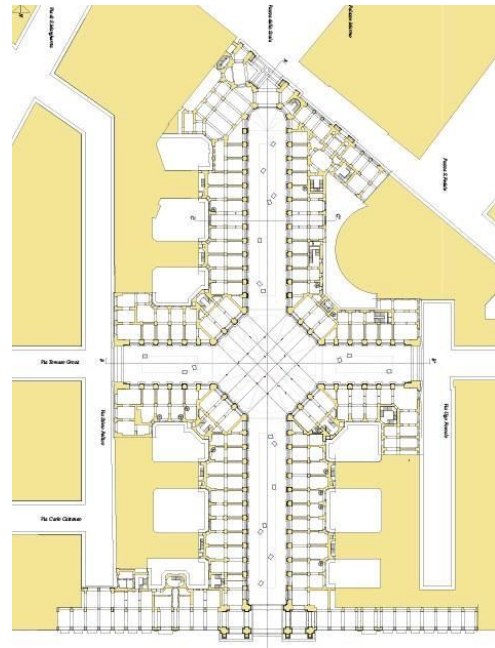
Planta Baixa da Galleria Vittorio Emanuele (1877), em Milão.
